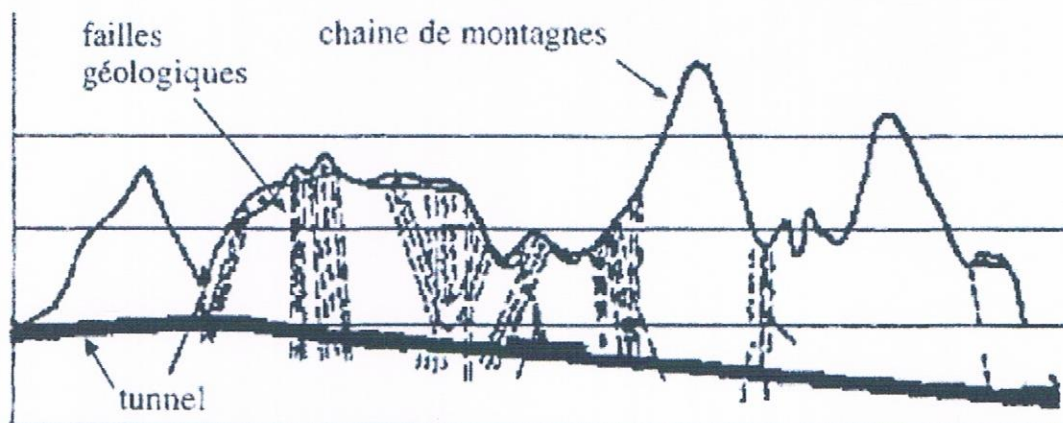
Coupe longitudinale du tracé d'un tunnel
